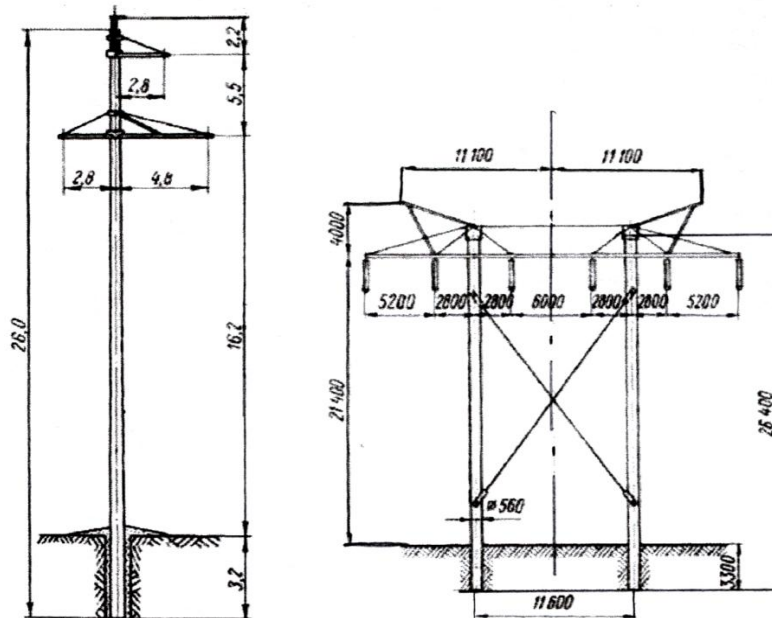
Промежуточная железобетонная опора ВЛ 220 кВ:
